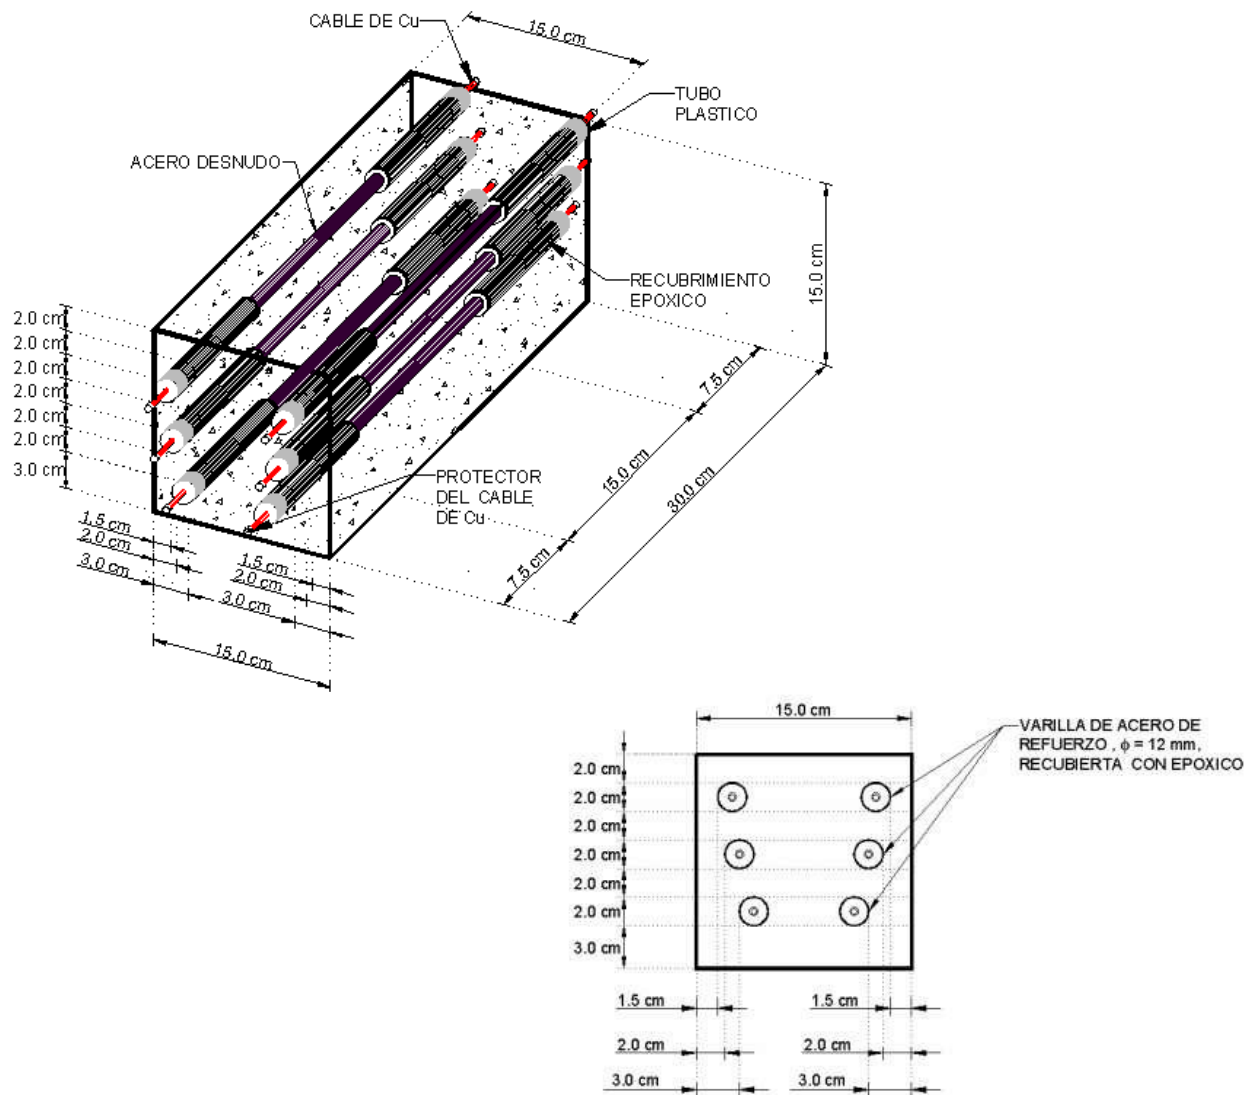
Detalle de distribución del acero de refuerzo en probetas de concreto (López-Celis, 2006).
